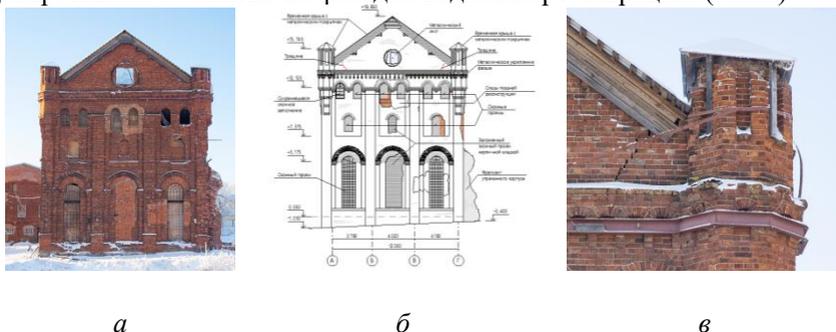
а) Восточный фасад, на момент 06.12.2024; б) Обмерный чертеж с картограммой дефектов; в) Фрагмент фасада с выбранным дефектом
